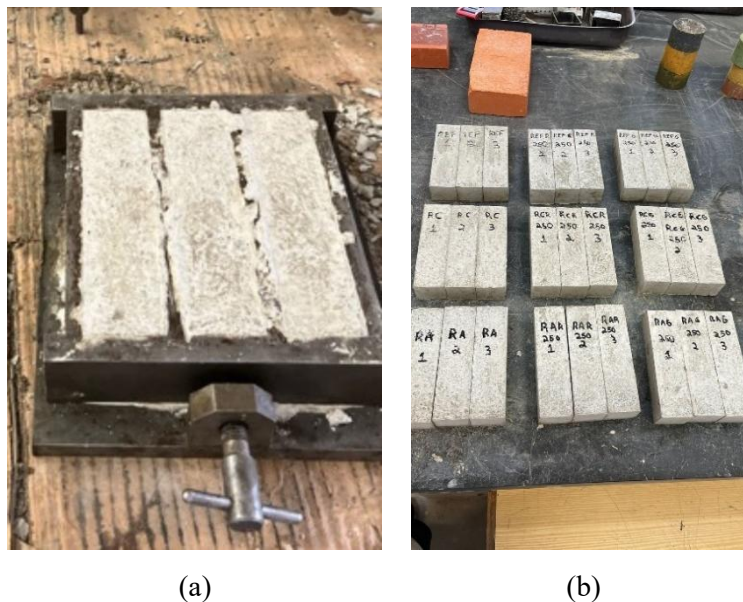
(a) Moldagem seca; (b) Provetes desmoldados e nomeados
